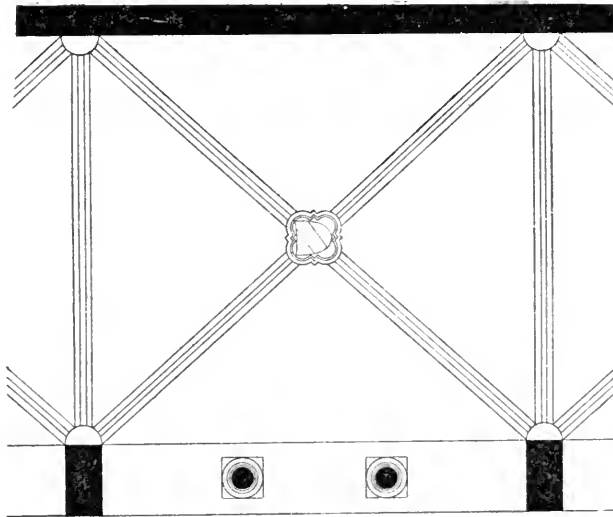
Grundriss eines Kreuzgangjoches.
